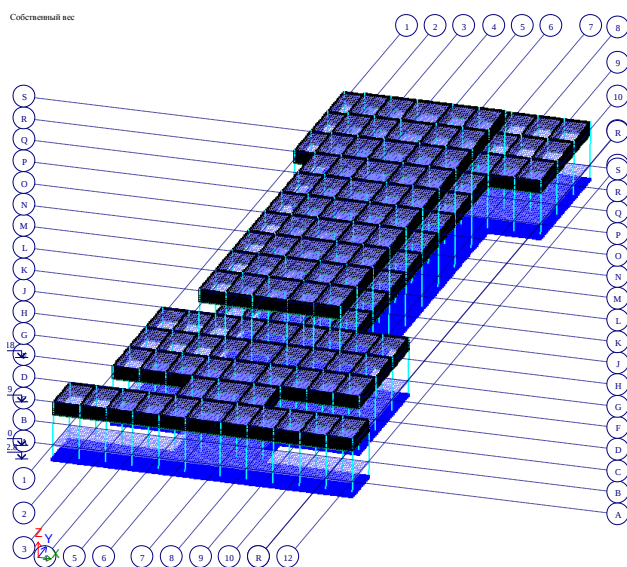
Расчетная схема здания в диметрической проекции
